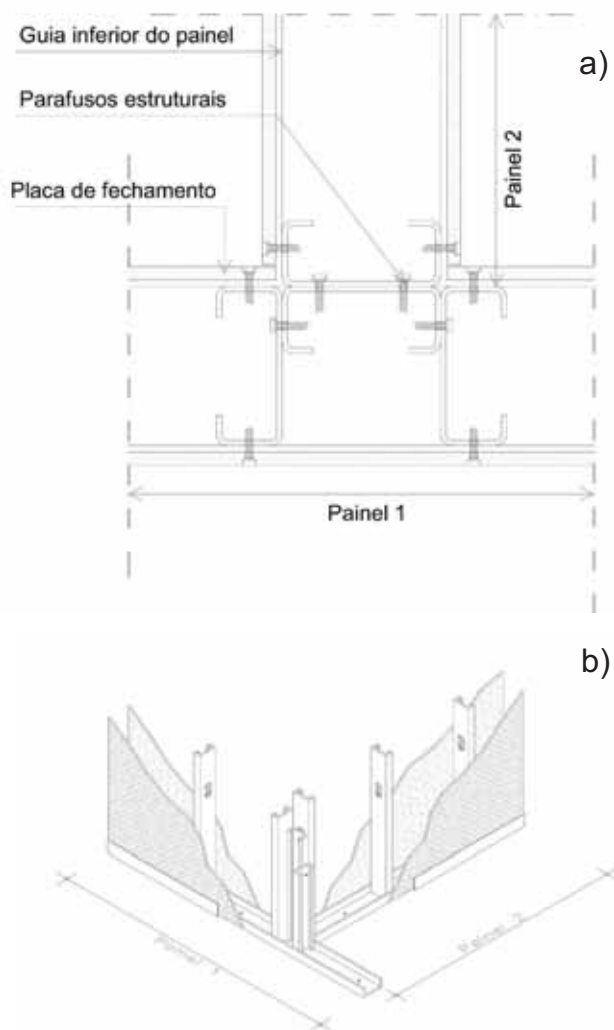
Ligação de dois painéis formando um “T”: a) planta; b) perspectiva.
